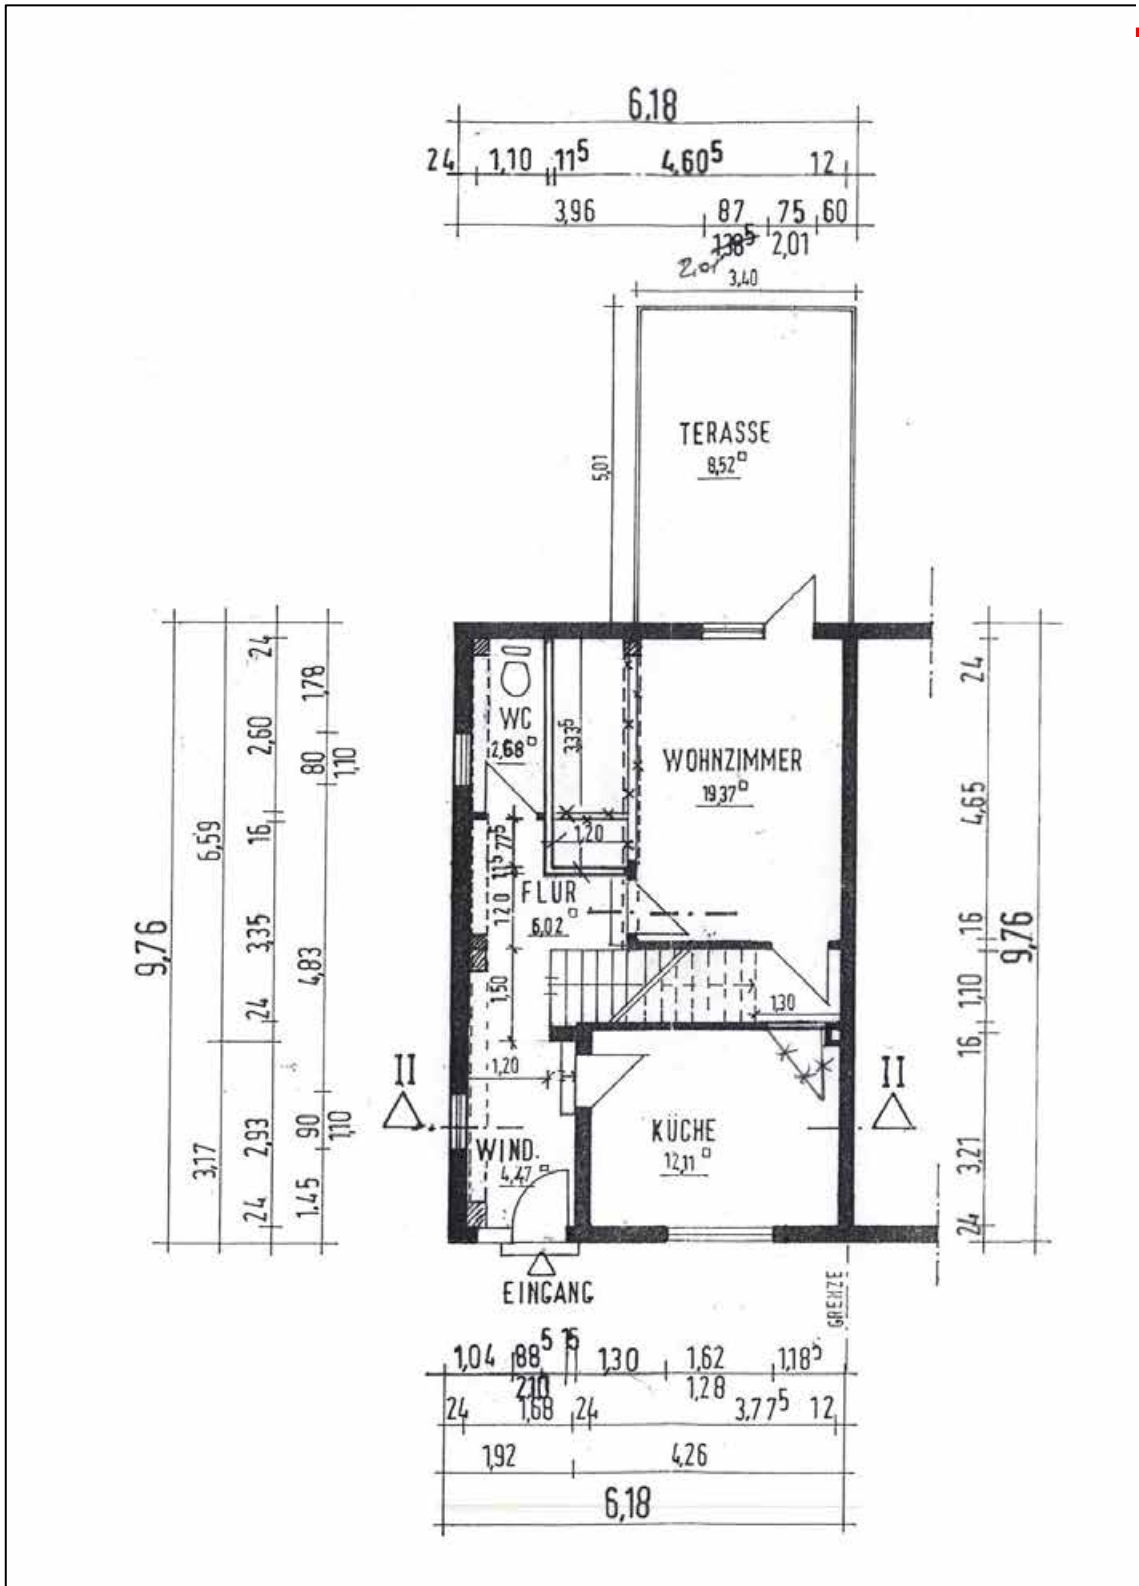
Erdgeschossgrundriss der Einfamilien-Doppelhaushälfte ohne Maßstab, in der Örtlichkeit modifiziert. aus den Bauakten der Stadt Hamm © Stadt Hamm
